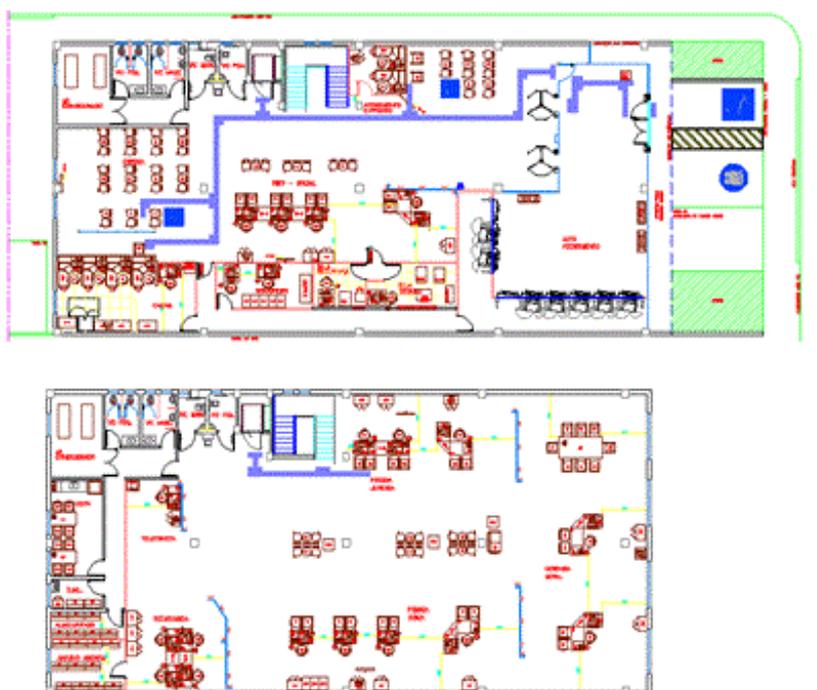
Planta baixa da agência bancária em Camboriú/Sc.
